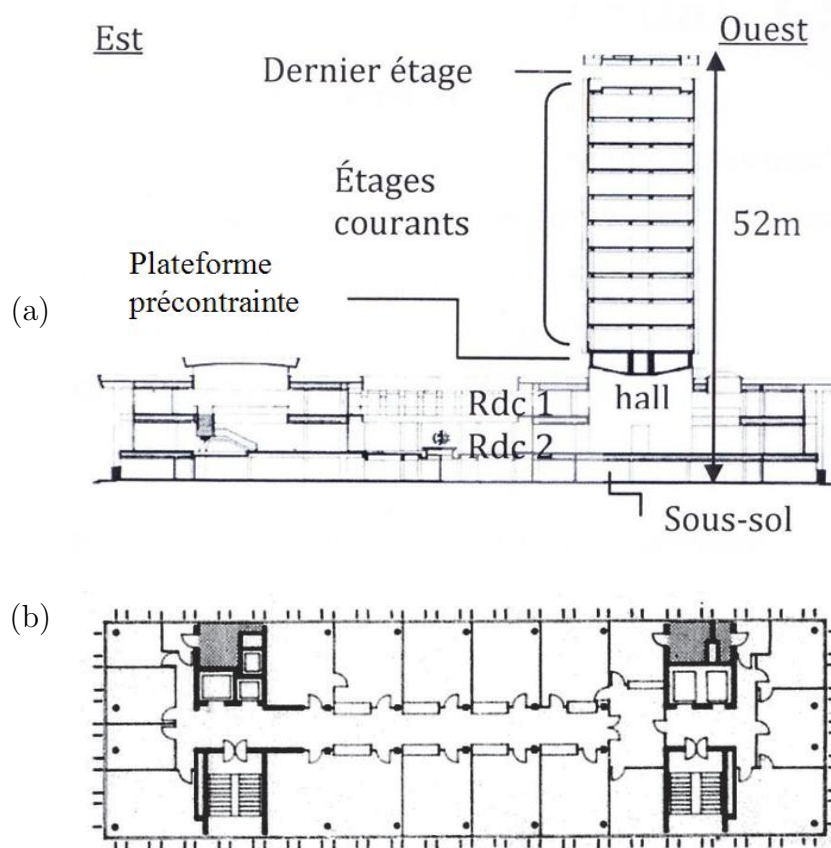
Hôtel de ville de Grenoble : (a) une section en élévation, (b) une section transversale. (source : Michel (2007))
